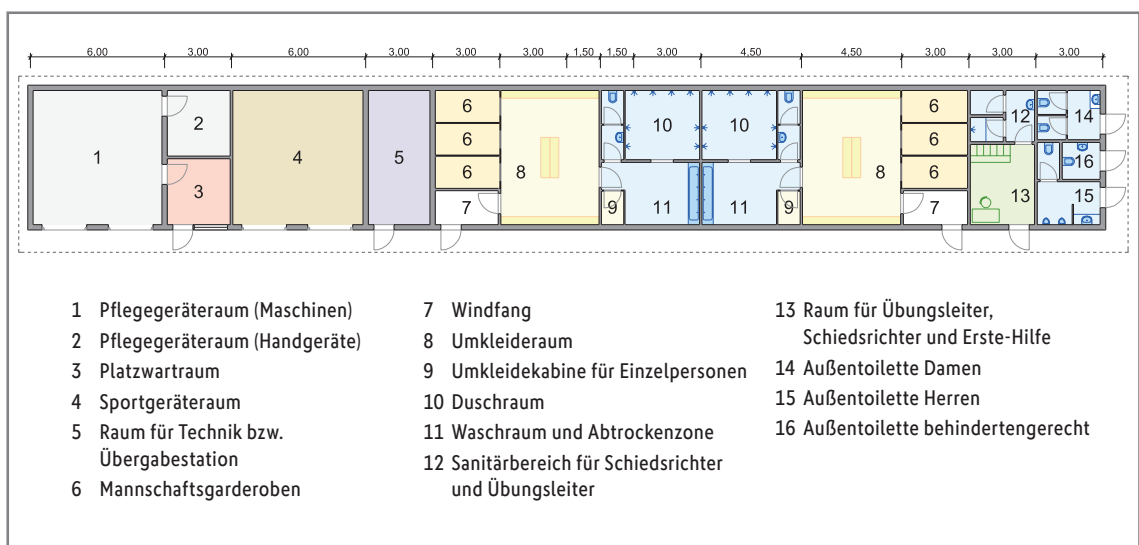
Schemagrundriss eines Funktionsgebäudes
